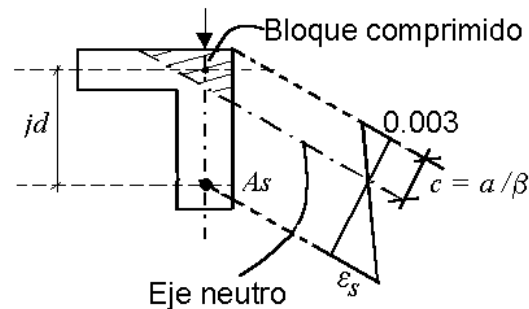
5 Inclinación del eje neutro en una sección asimétrica con plano de cargas
